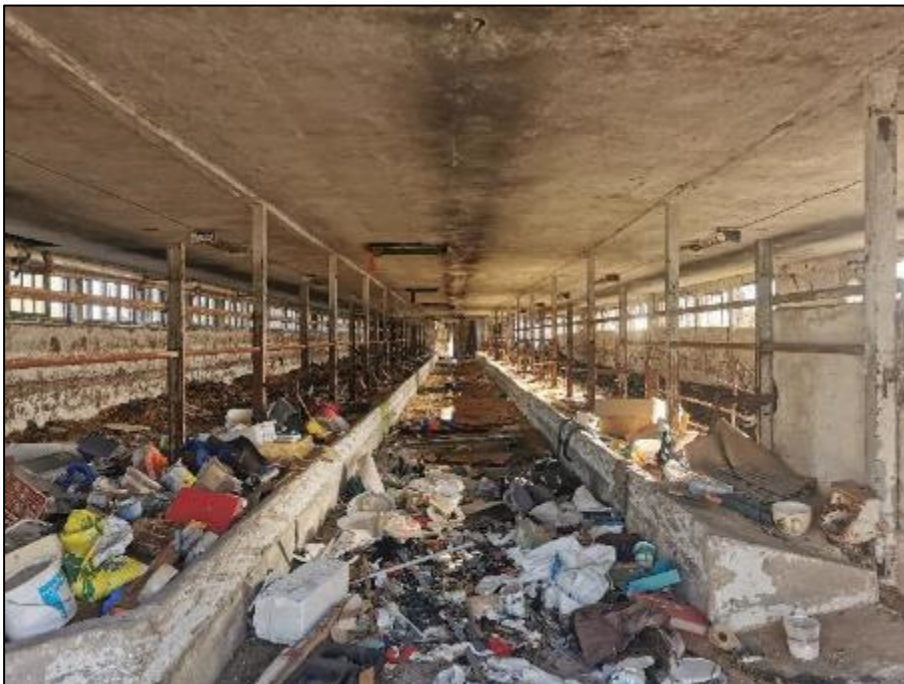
Vermüllung im Stall (Foto 10.04.2020).
